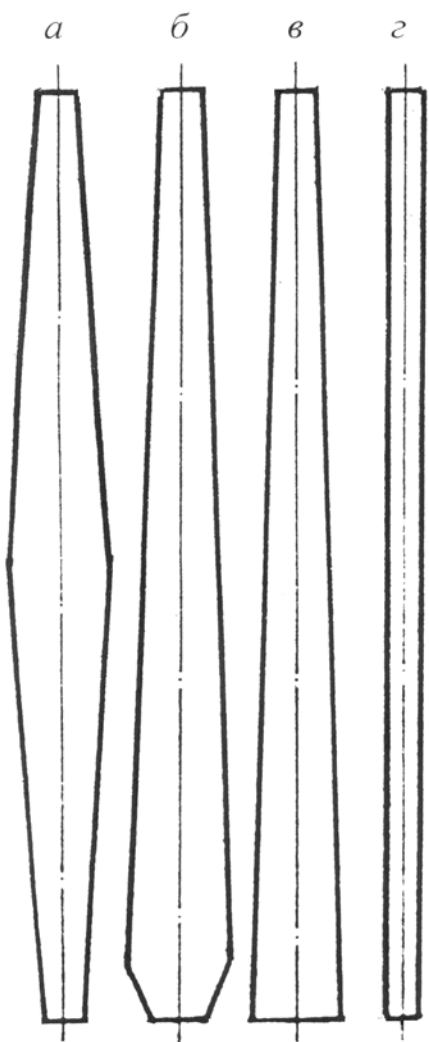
Формы продольных сечений железобетонных свай:
